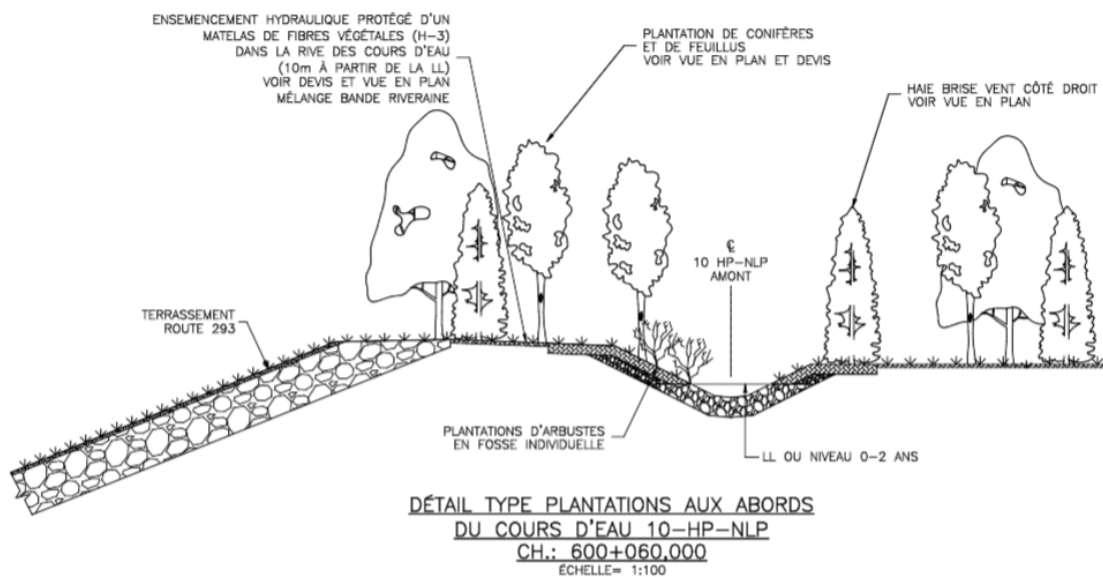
Extrait des plans TP : plantations aux abords du cours d'eau 10-NHP-NLP
